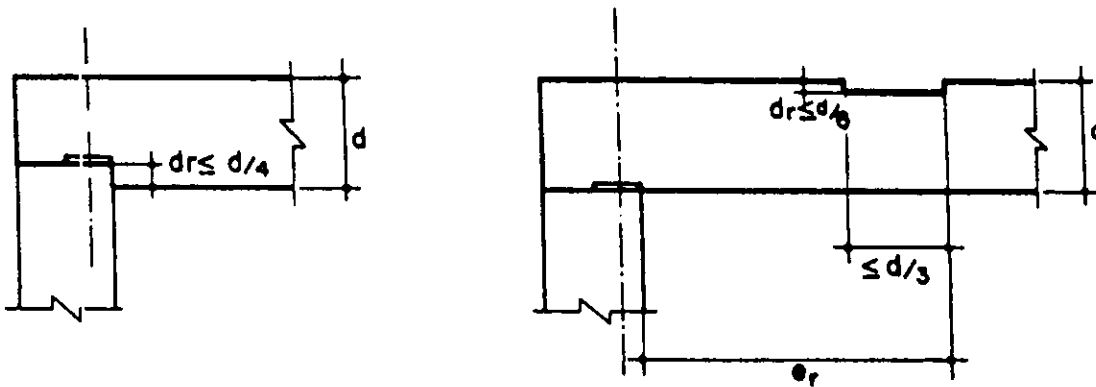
NOTACION PARA REVISION DE CORTANTE EN VIGAS CON RECORTES
